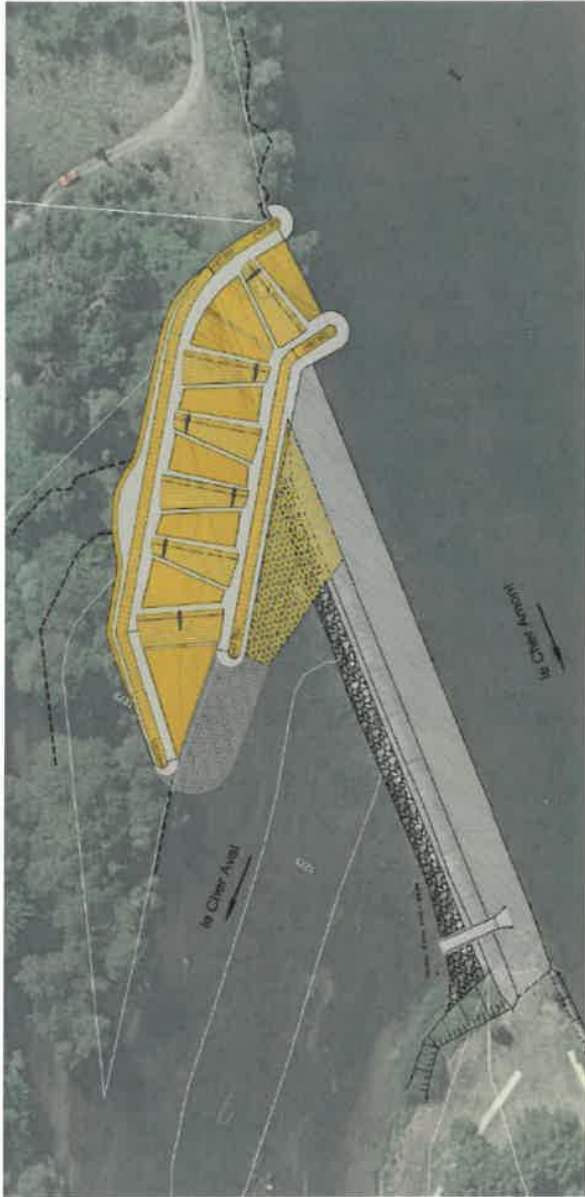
Vue en plan du dispositif de franchissement (source : dossier d'autorisation)
